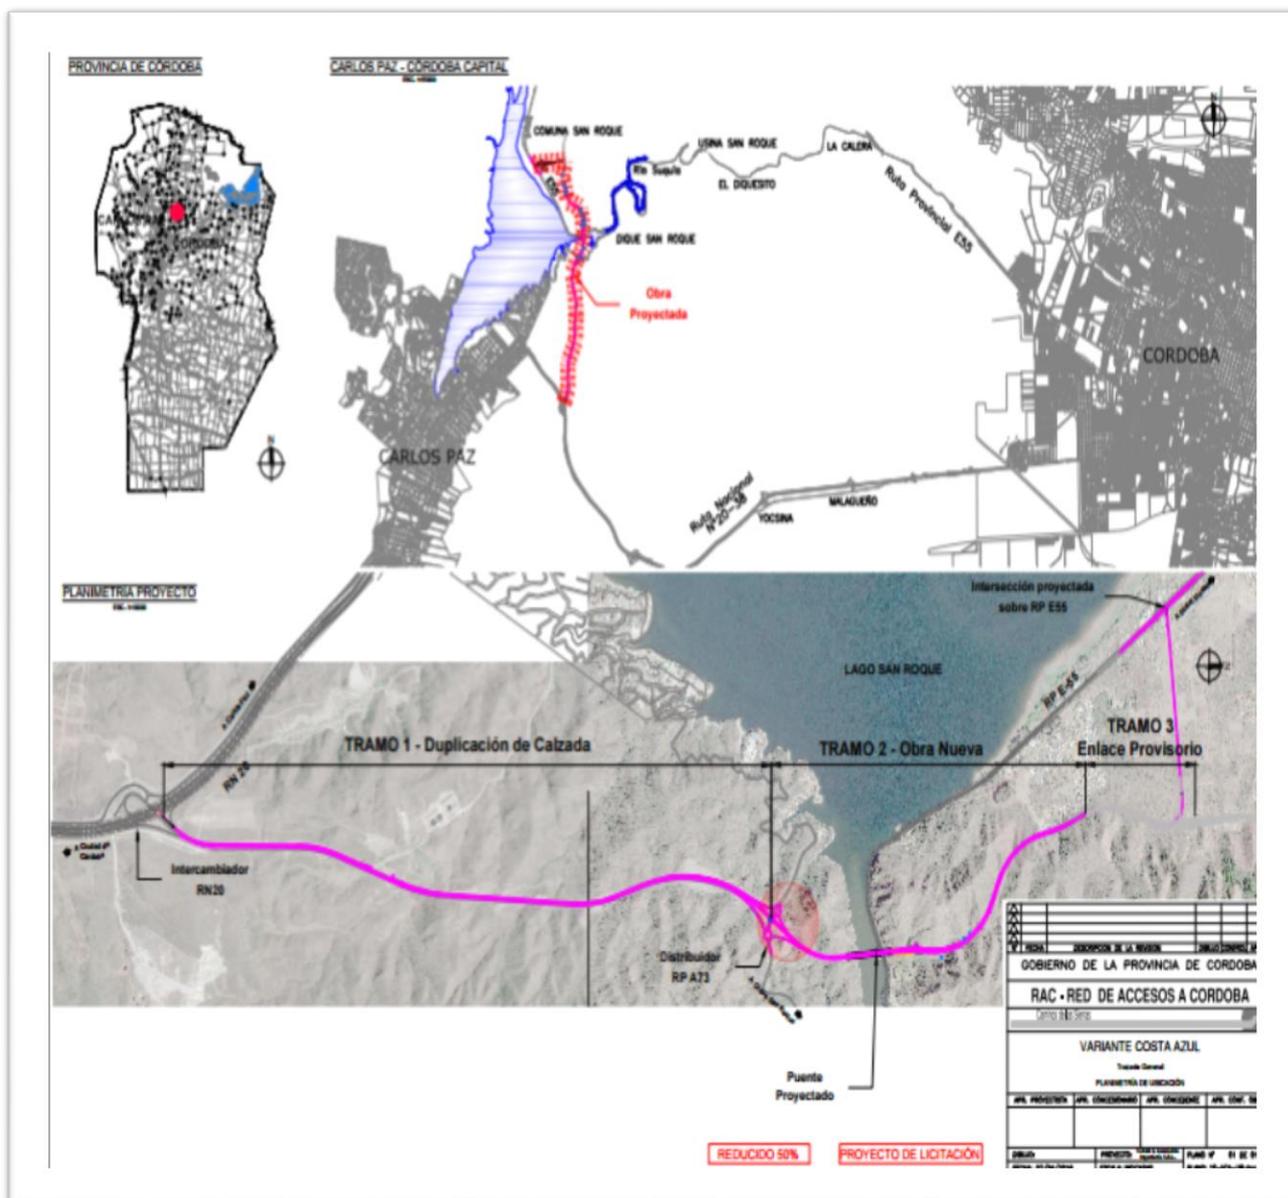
Variante Costa Azul. Trazado General. Planimetría de la ubicación.
